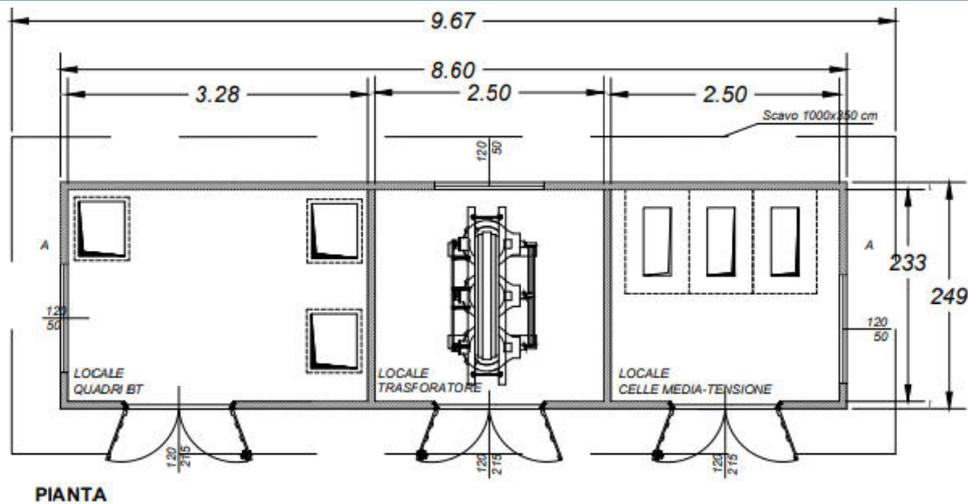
Schematizzazione in pianta cabina di trasformazione.
